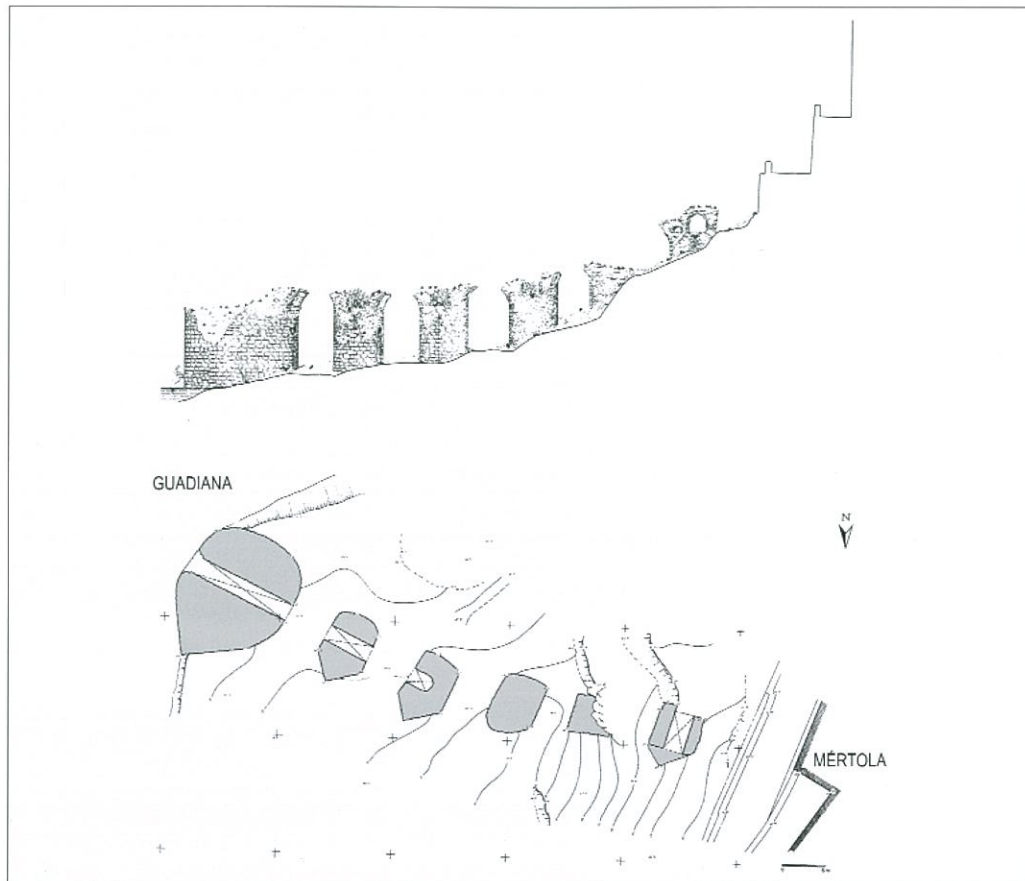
Planta y Alzado de la Torre del Río de Mértola
